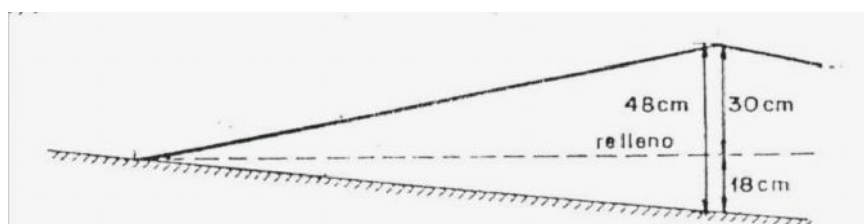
Corte y Relleno Necesarios para Construir la Terraza
